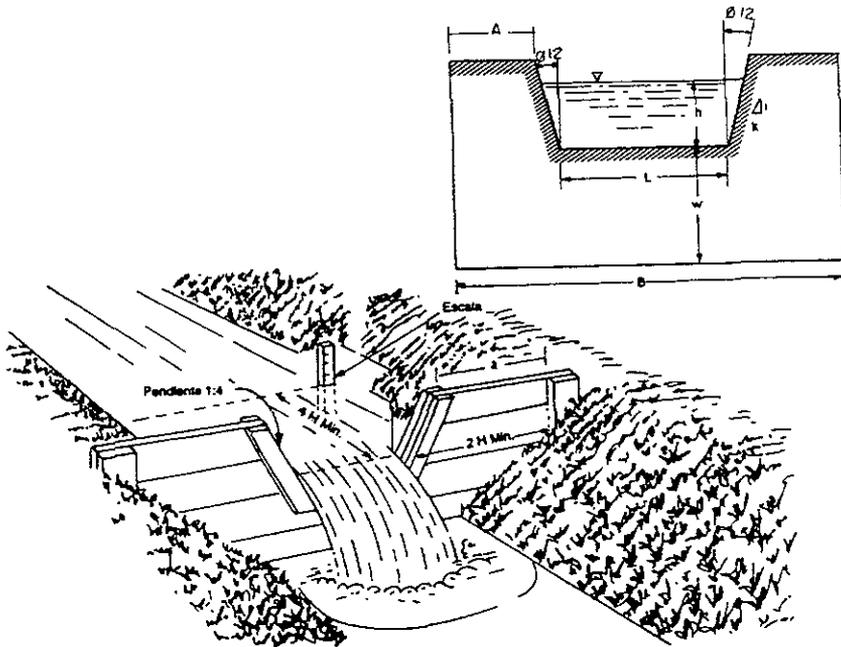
Vertedor Trapezoidal Cipolletti (ref 4)
